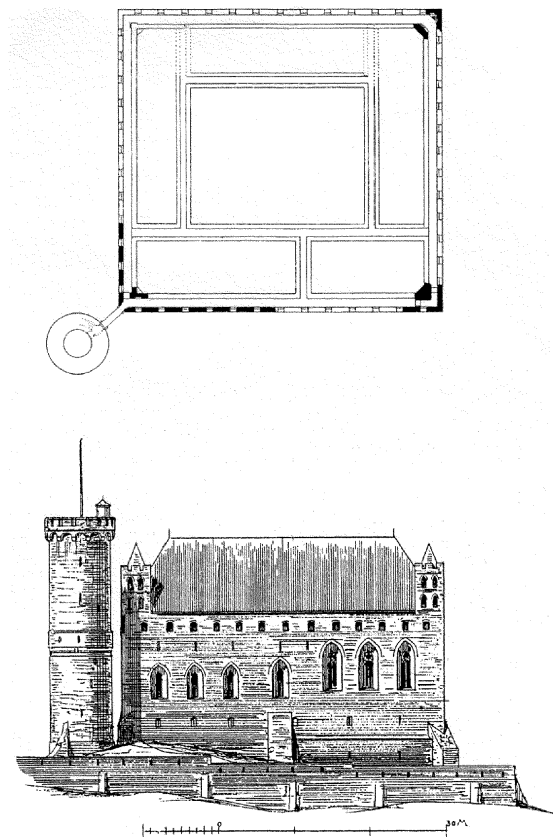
Gollub/Golub. Grundriß des Wehrganges und die Hauptfassade (Kirchenflügel) mit Bergfried, z. T. rekonstruiert. Nach C. Steinbrecht.
